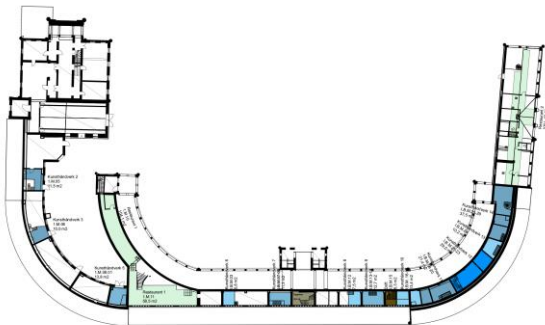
Plan 1. et basarer. Bakkeplan indre gård.
